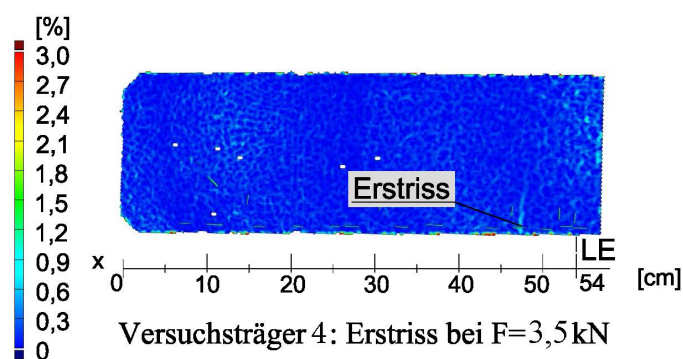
Versuchsträger 4- Lage Erstriss
